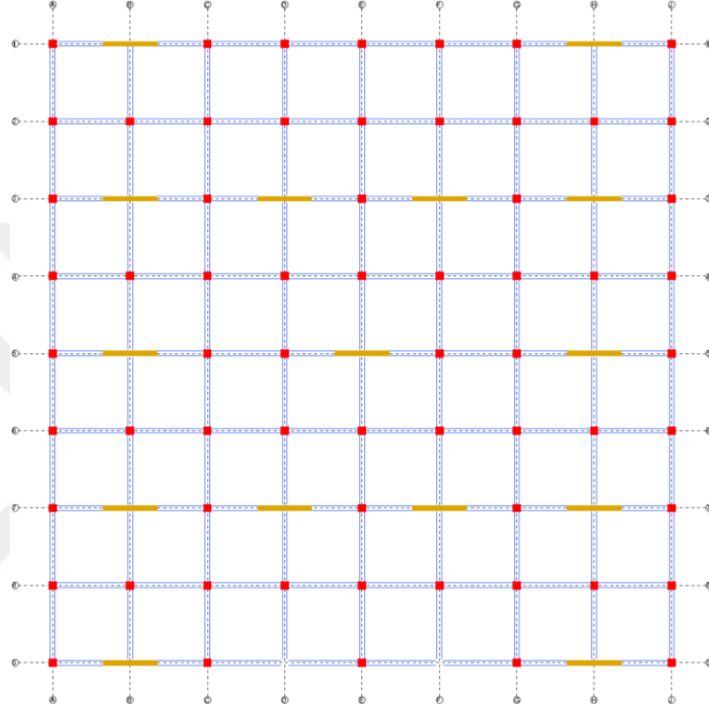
Model 10.2 'ye Ait Kat Planı
